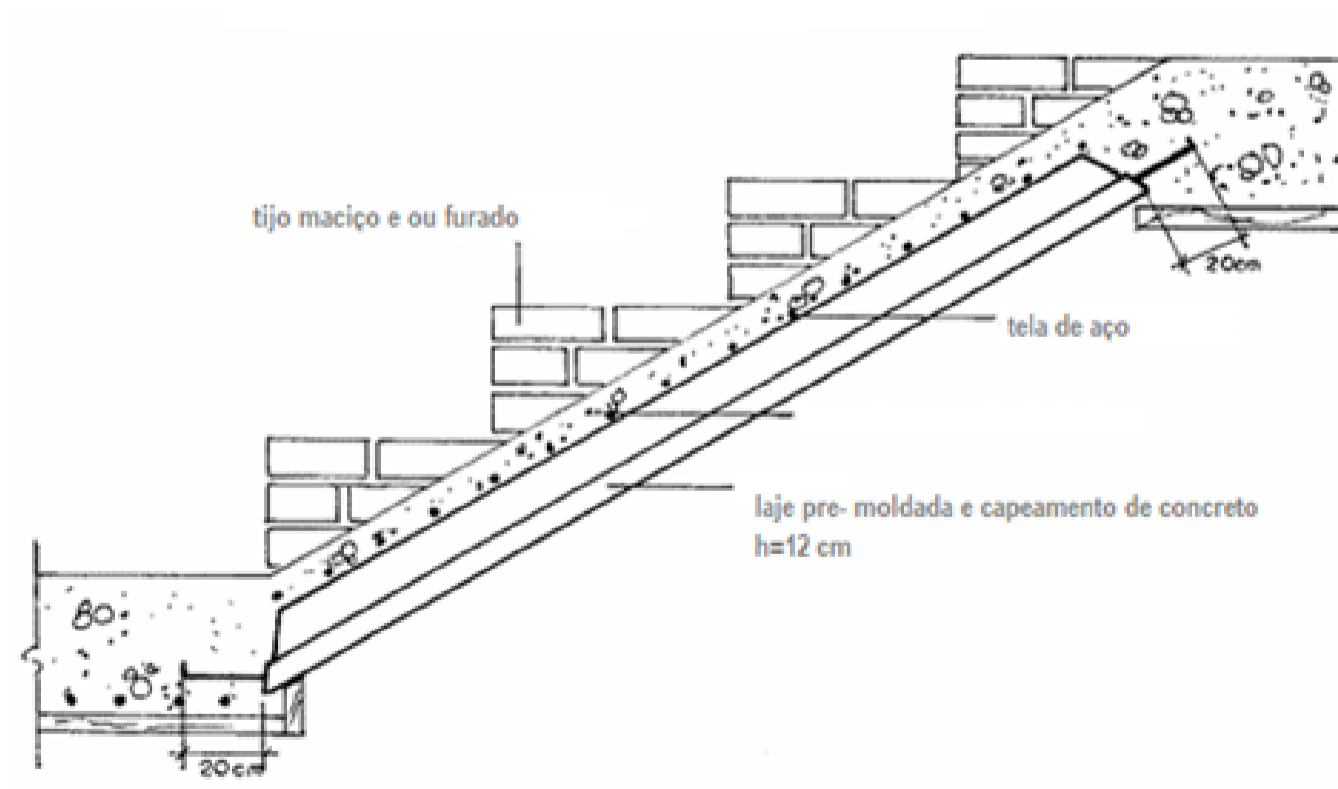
Degraus com Tijolos maciços e furados utilizando laje pre moldada
